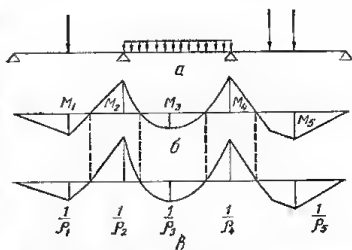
Расчетная схема (а), эпюра изгибающих моментов (б) и эпюра кривизн (в) в железобетонной балке.
